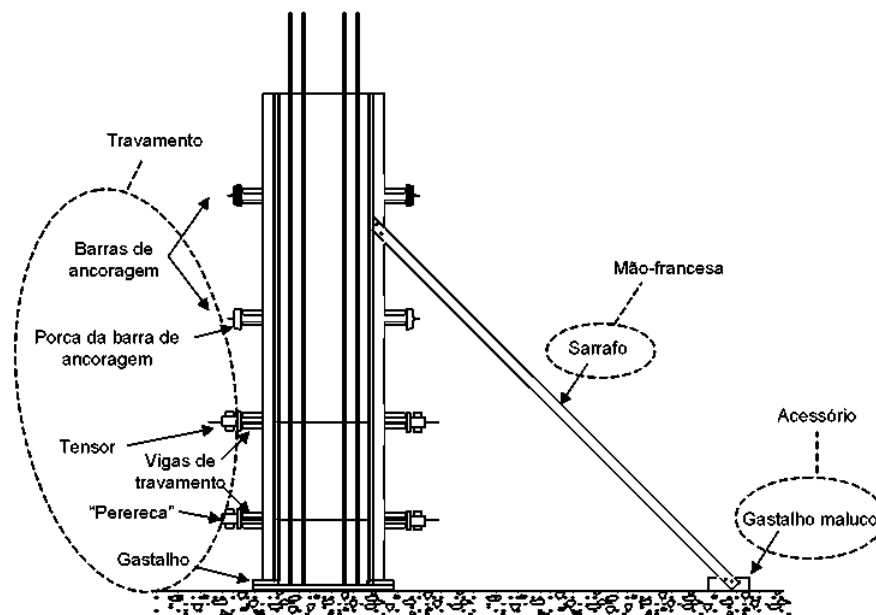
Corte do pilar com fôrma com travamento composto por vigas de travamento, barras de ancoragem e tensores e mão francesa com sarrafo.
